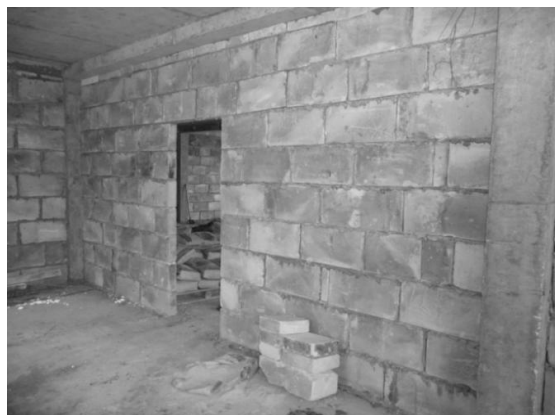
Кладка стін з пінобетонних блоків в каркасному житловому будинку в м. Кропивницький по вул. Васильківського
